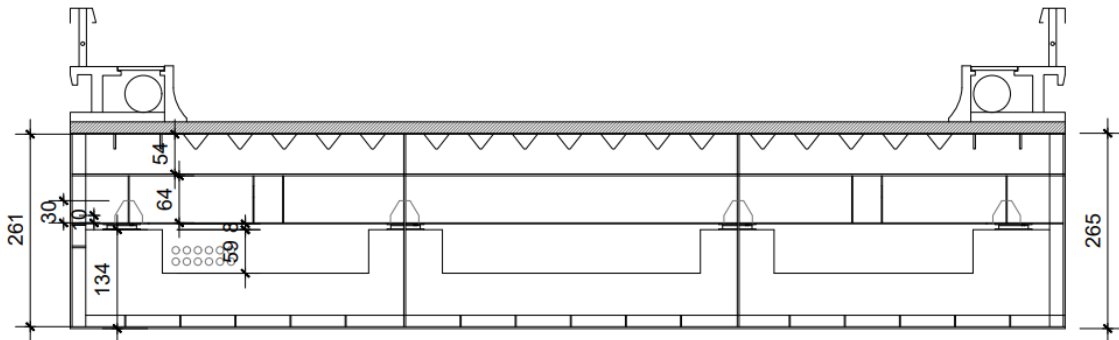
Corte transversal do tabuleiro metálico. Fonte: Almeida et al. [6]
